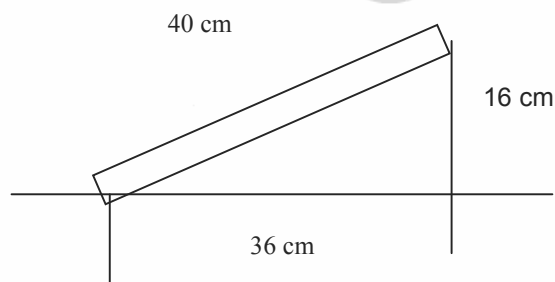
Susunan panel dimensi 40cm x 40cm dengan tipe *solid overhang* dan *inclined wall*.
